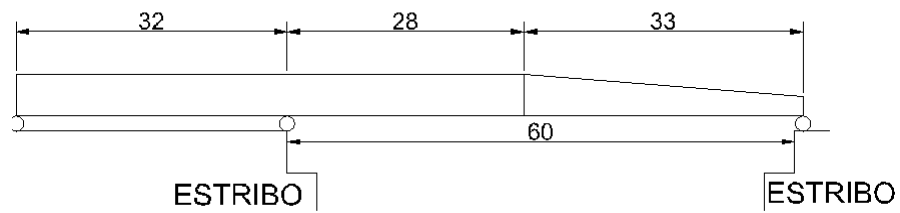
Conjunto estructural apoyado en los dos estribos
